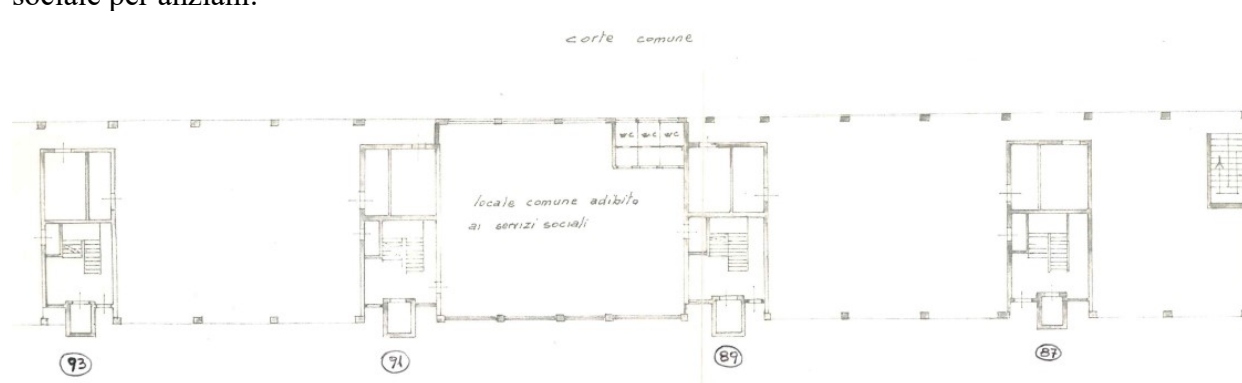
Stralcio pianta piano terra di via Radini Tedeschi
